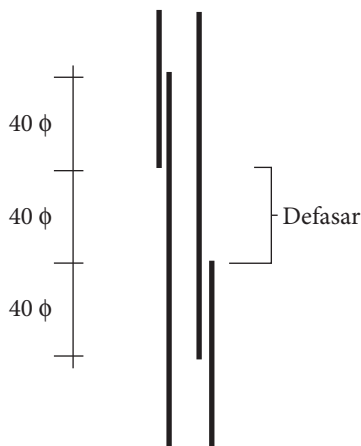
Emendas de duas barras no mesmo furo (recomenda-se utilizar apenas uma barra vertical por furo).
